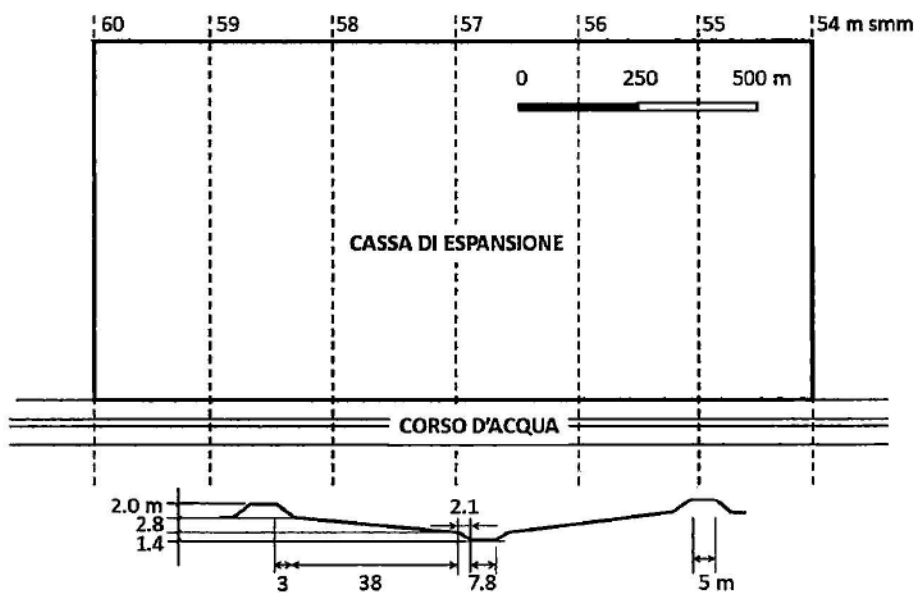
schema planimetrico con l'indicazione dell'area della cassa, le quote del terreno in m s.m.m. e la sezione tipo del corso d'acqua
